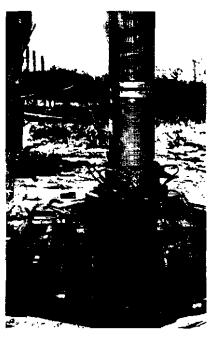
Introduciendo una rejilla Johnson en un pozo de 40 cm. Los tramos de rejilla han sido armados mediante soldadura en sitio.
